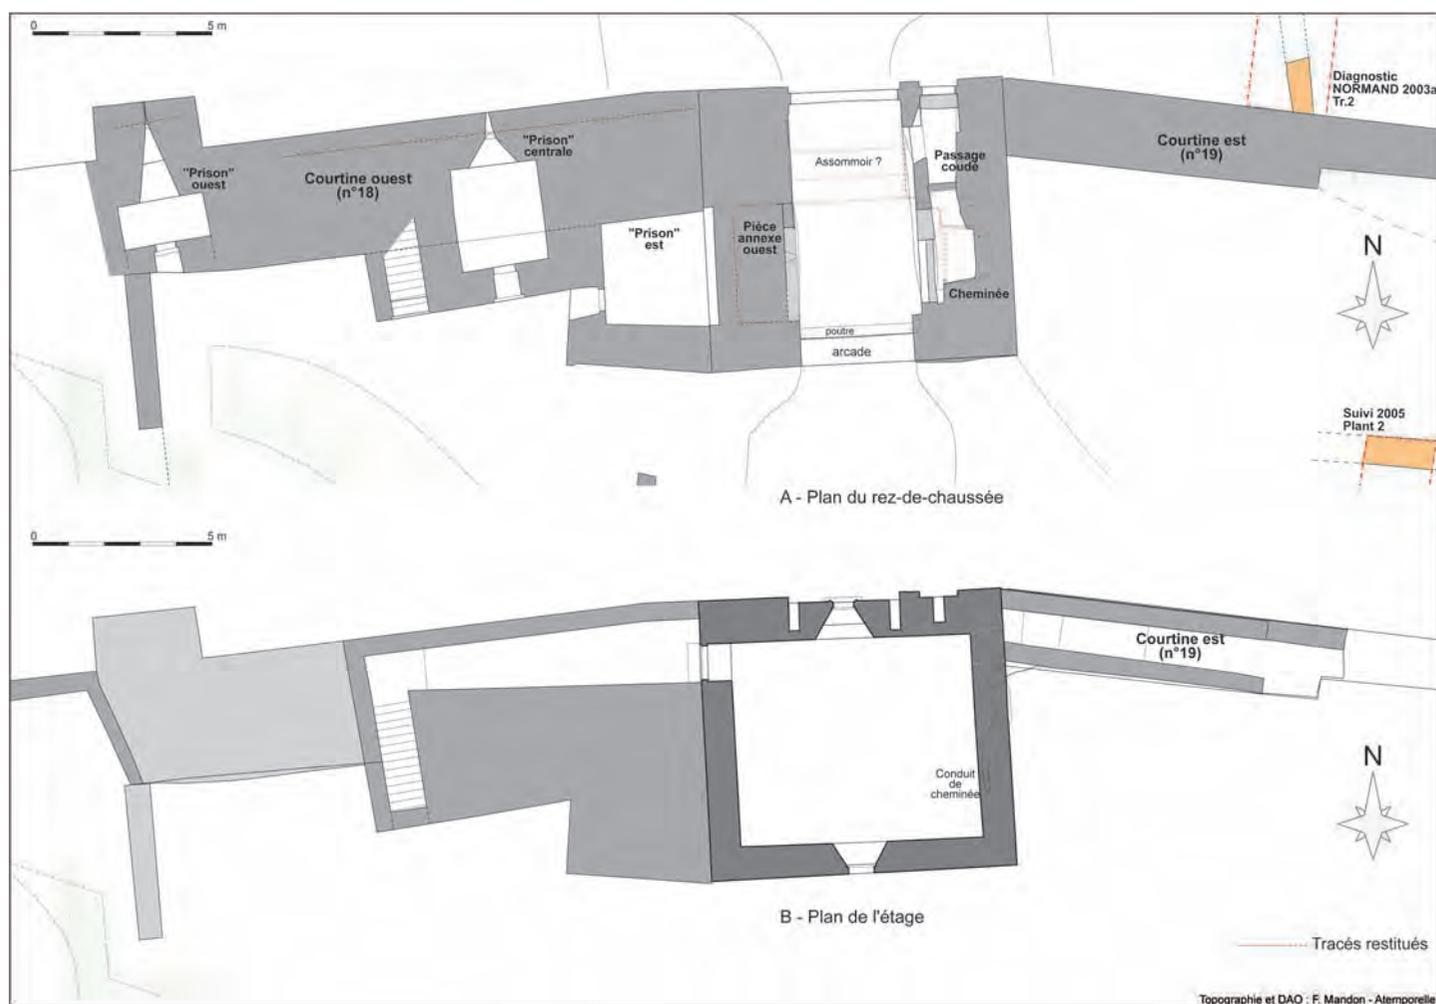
Surgères, plan d'ensemble de la porte nord du château (rez-de-chaussée et étage) (Topographie et DAO : F. Mandon, Atemporelle).
